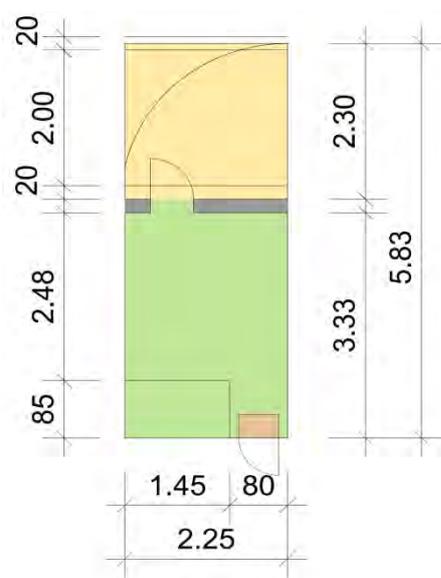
Grundriss der Abferkelbucht des Modellstalls mit Innenfütterung
